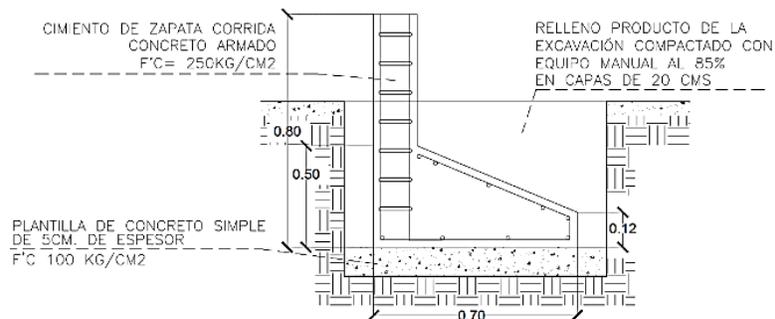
Zapata corrida para cimentación (Elaboración propia, 2021)
